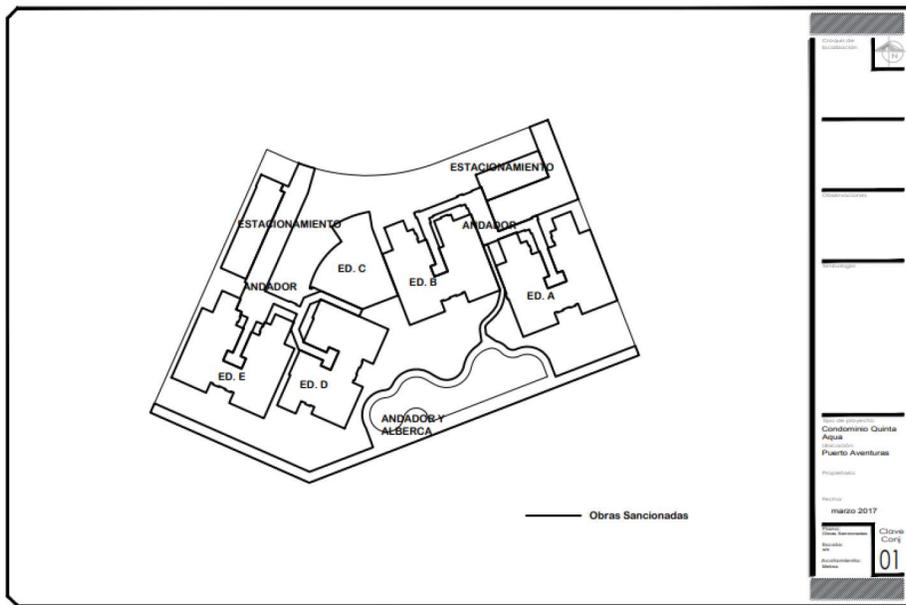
Planta de conjunto de las obras sancionadas.
